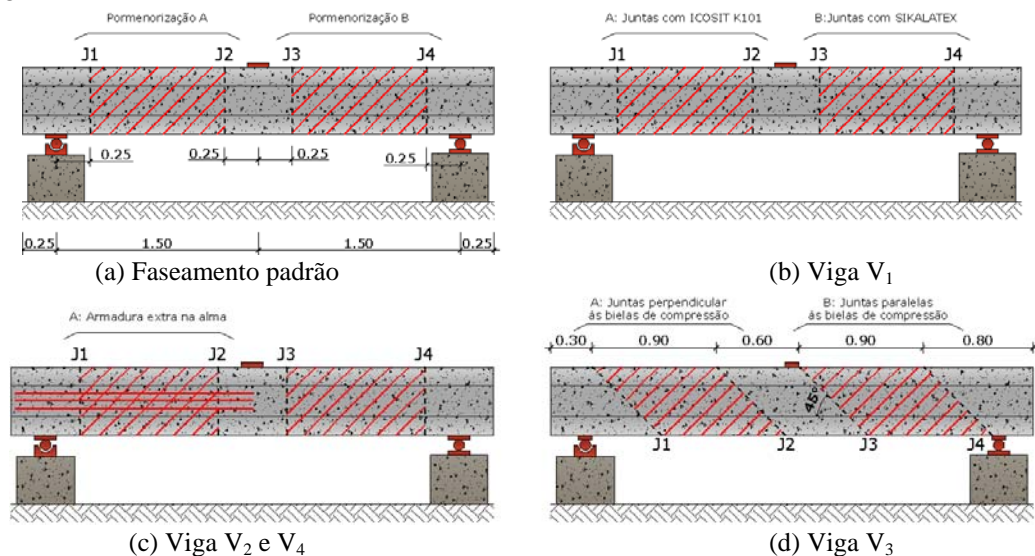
Faseamento construtivo das vigas ensaiadas na 2ª fase.
